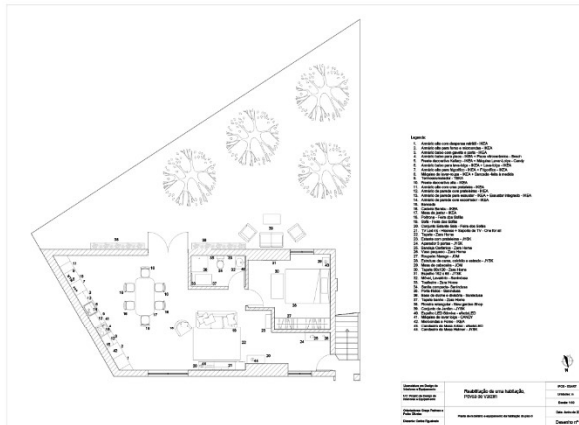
Planta de Mobiliário Habitação Piso 0. Fonte: Autor.
